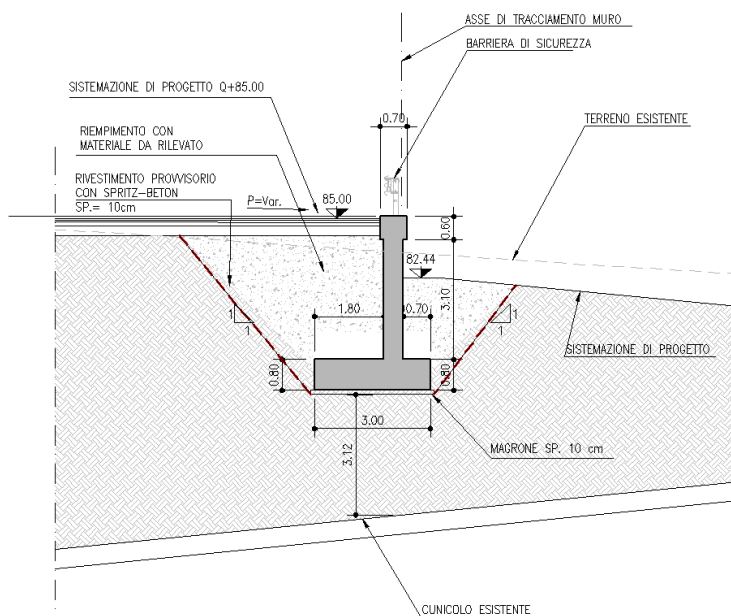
Muro di sostegno MS02 – Sezione tipo 2
